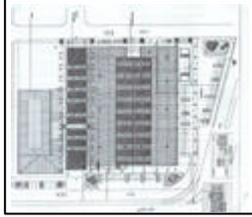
Planta– Manejo del Espacio Público- Proyecto de La Plaza de Mercado de la Esmeralda.
